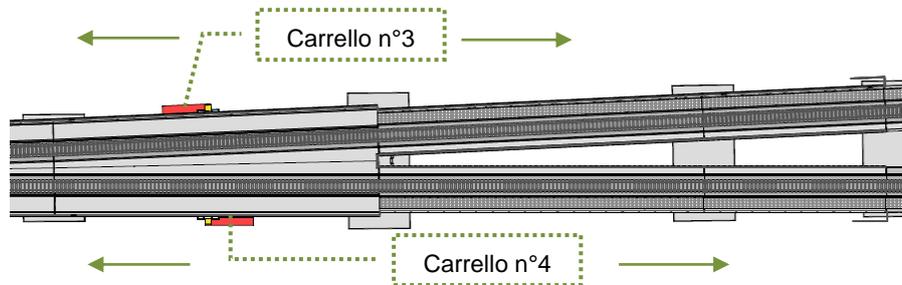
Inquadratura planimetrica del viadotto Cervaro con indicazione dei 4 carrelli mobili di ispezione (Pianta 2/2).
